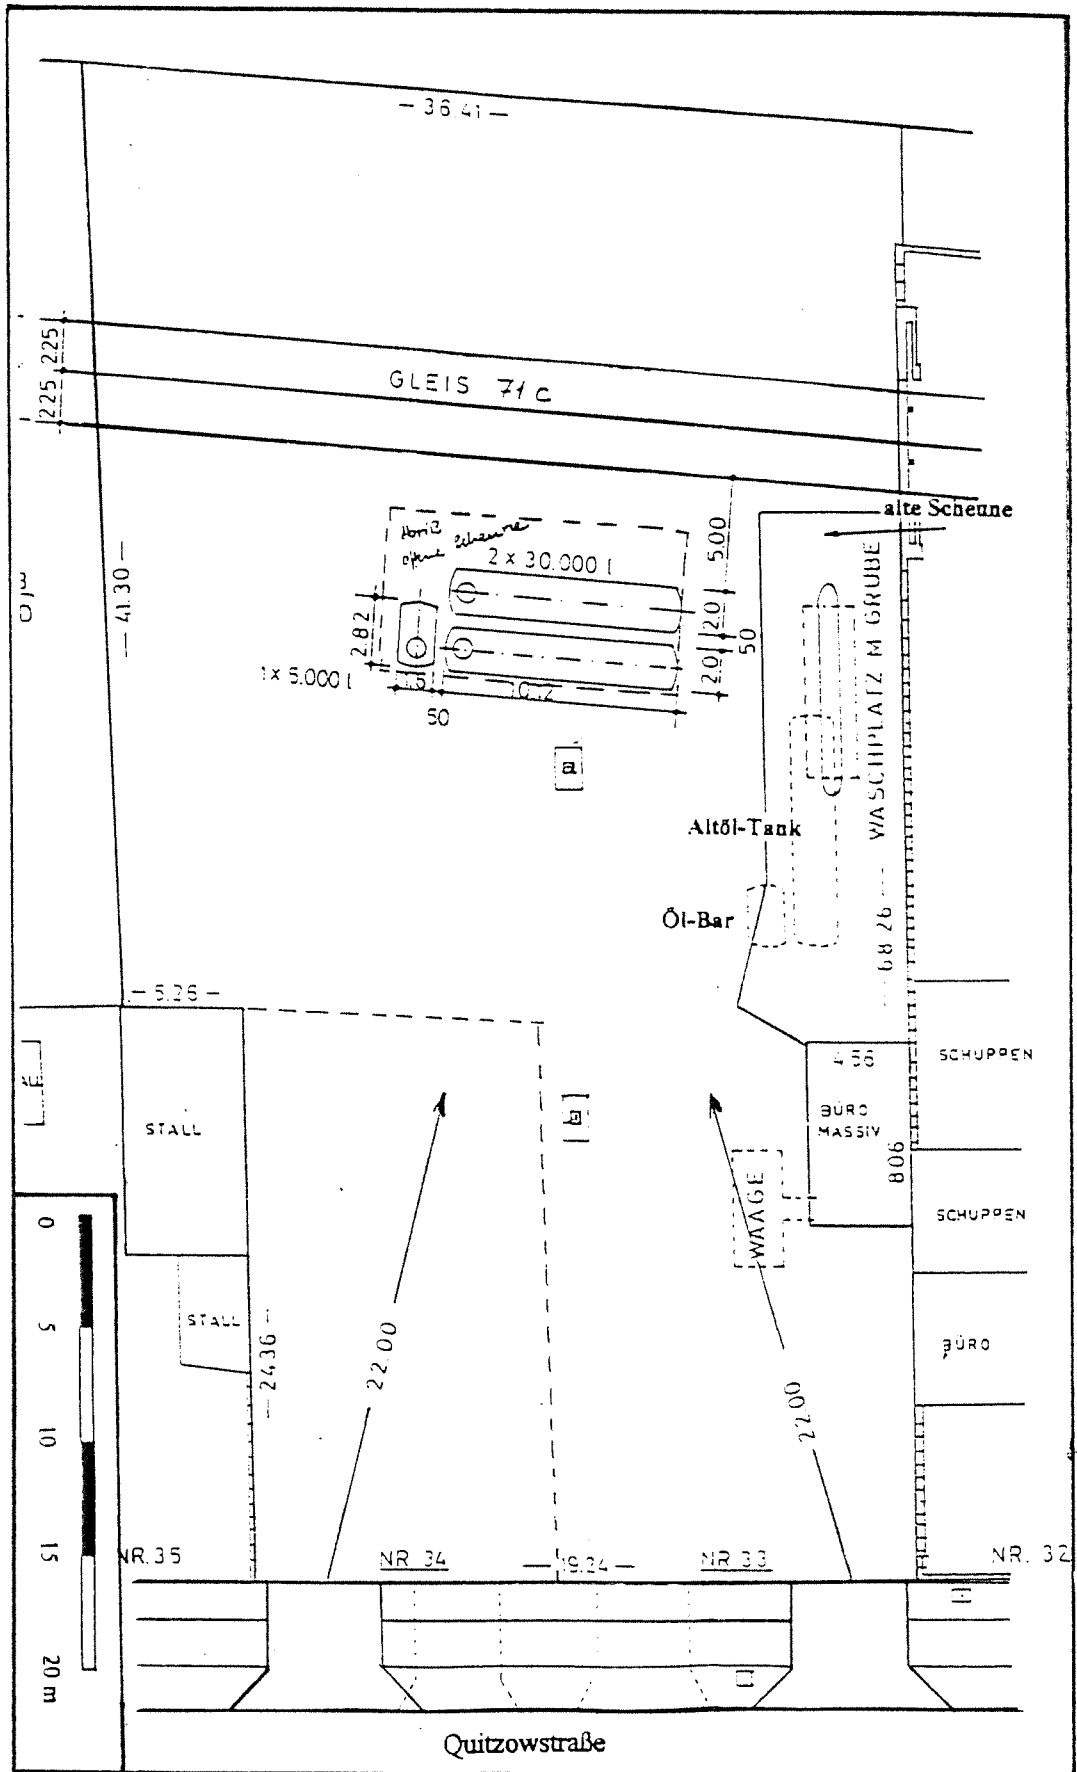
b : Verdachtsfläche 8 - Bebauungssituation 1962 (Nr.33-34)
